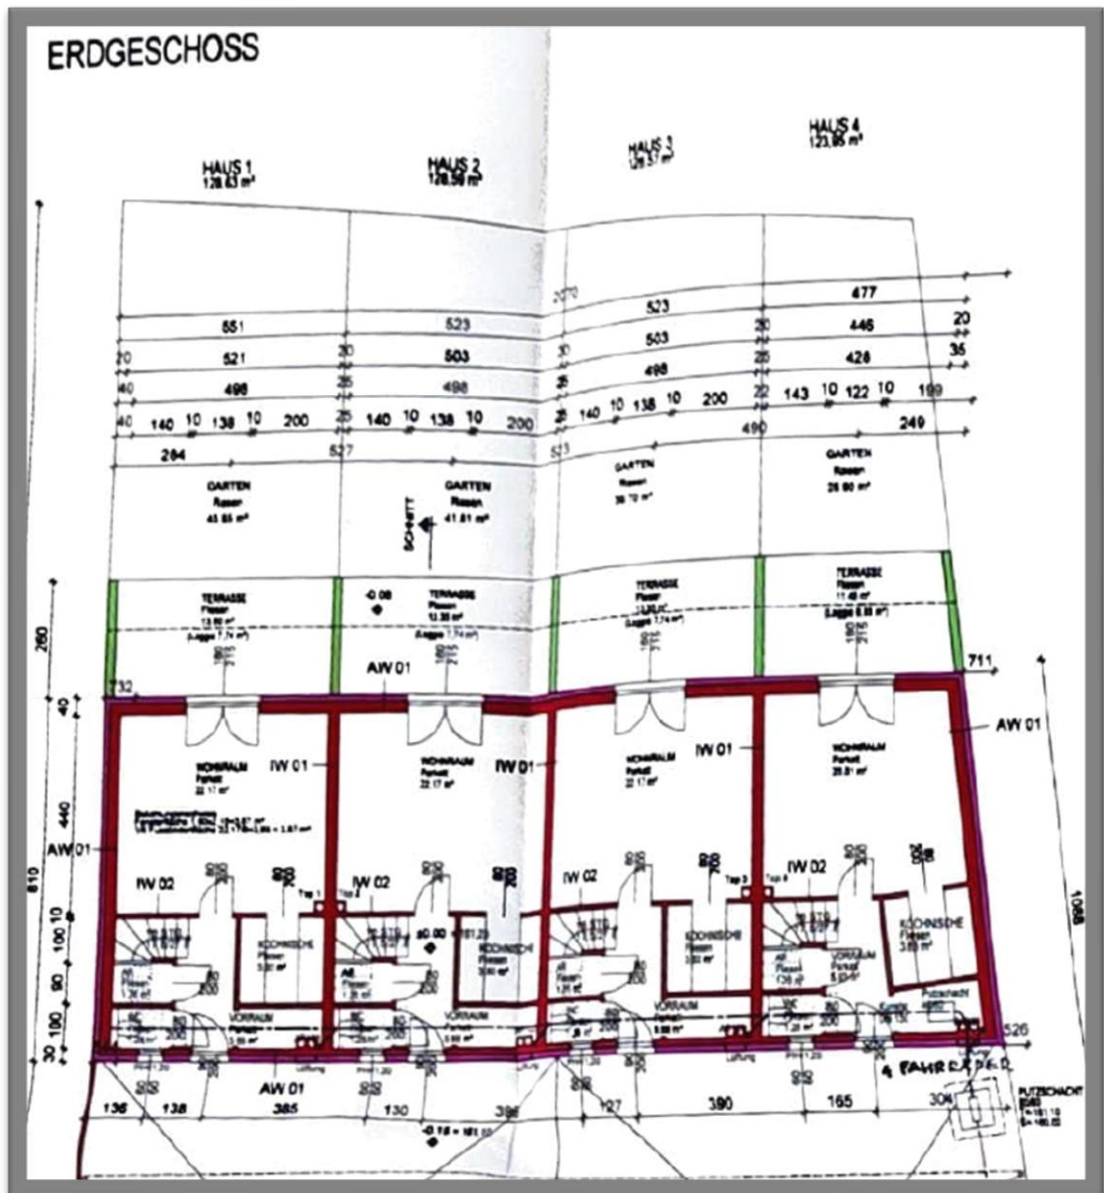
Grundriss EG - Haus 1-4
